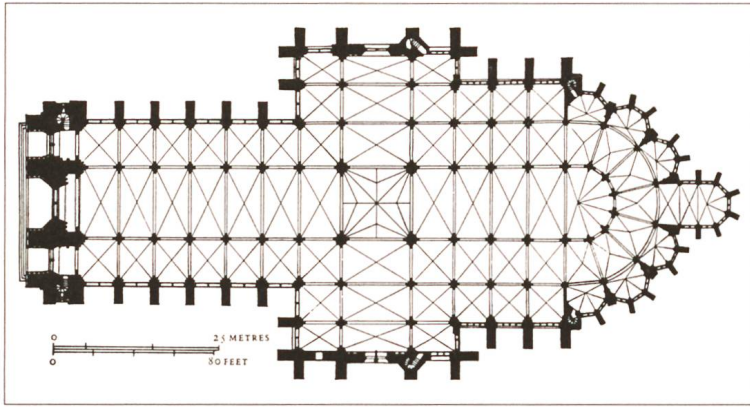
Grundriss der Kathedrale Notre Dame d'Amiens.
